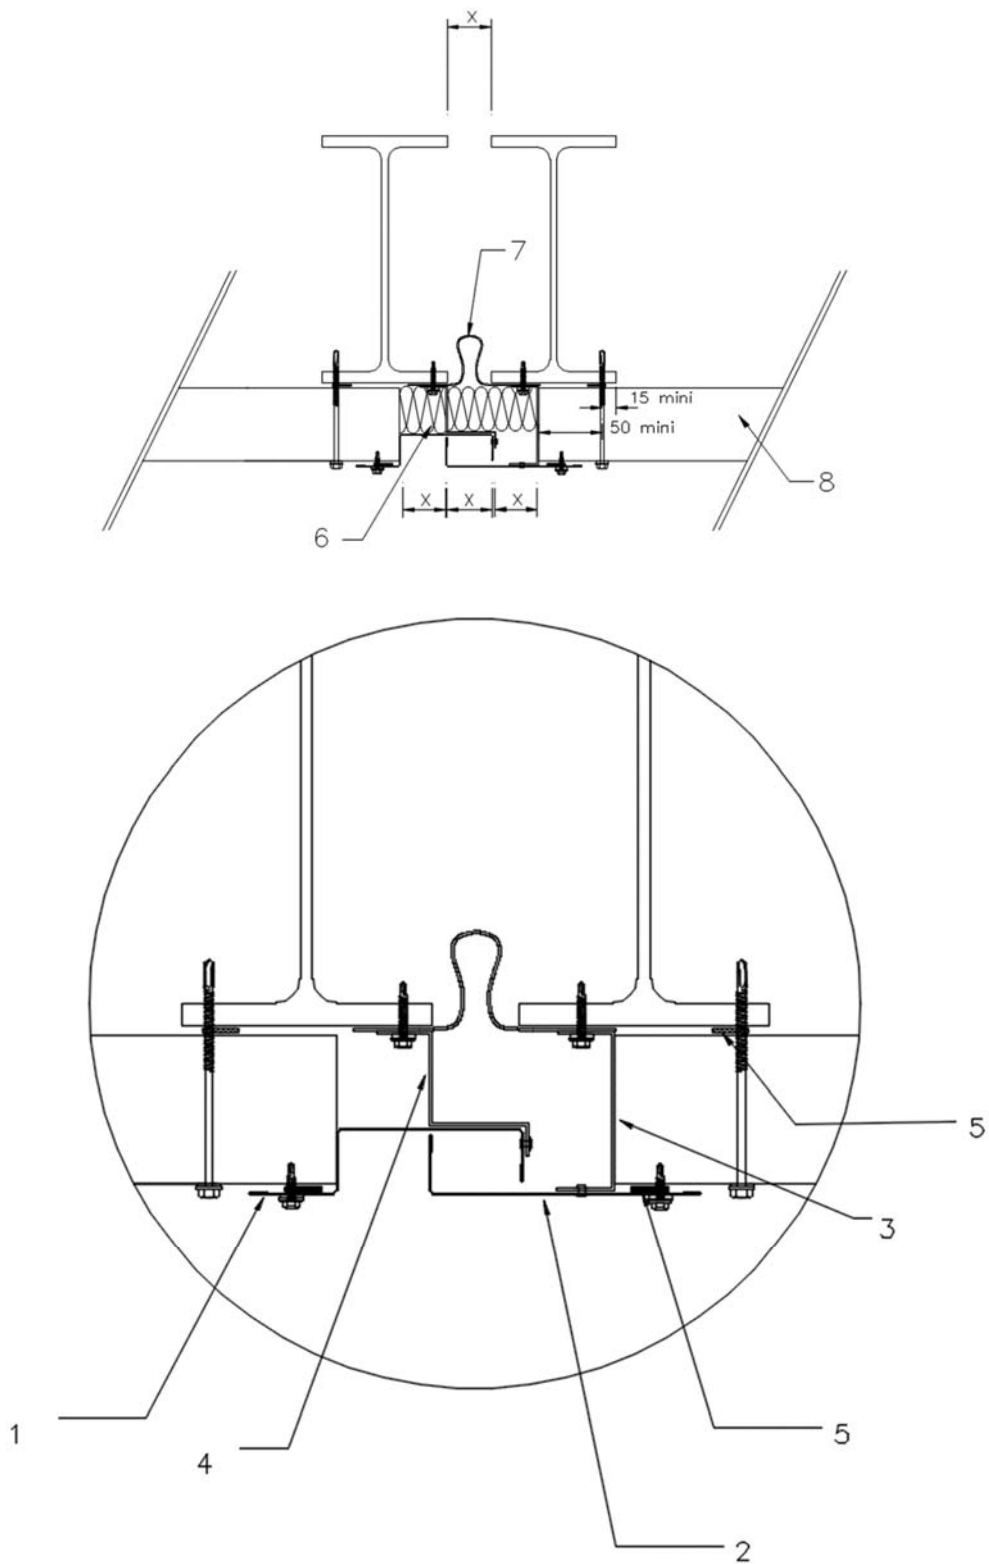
Baie en pose horizontale (hauteur maximale des baies de 20 m)
